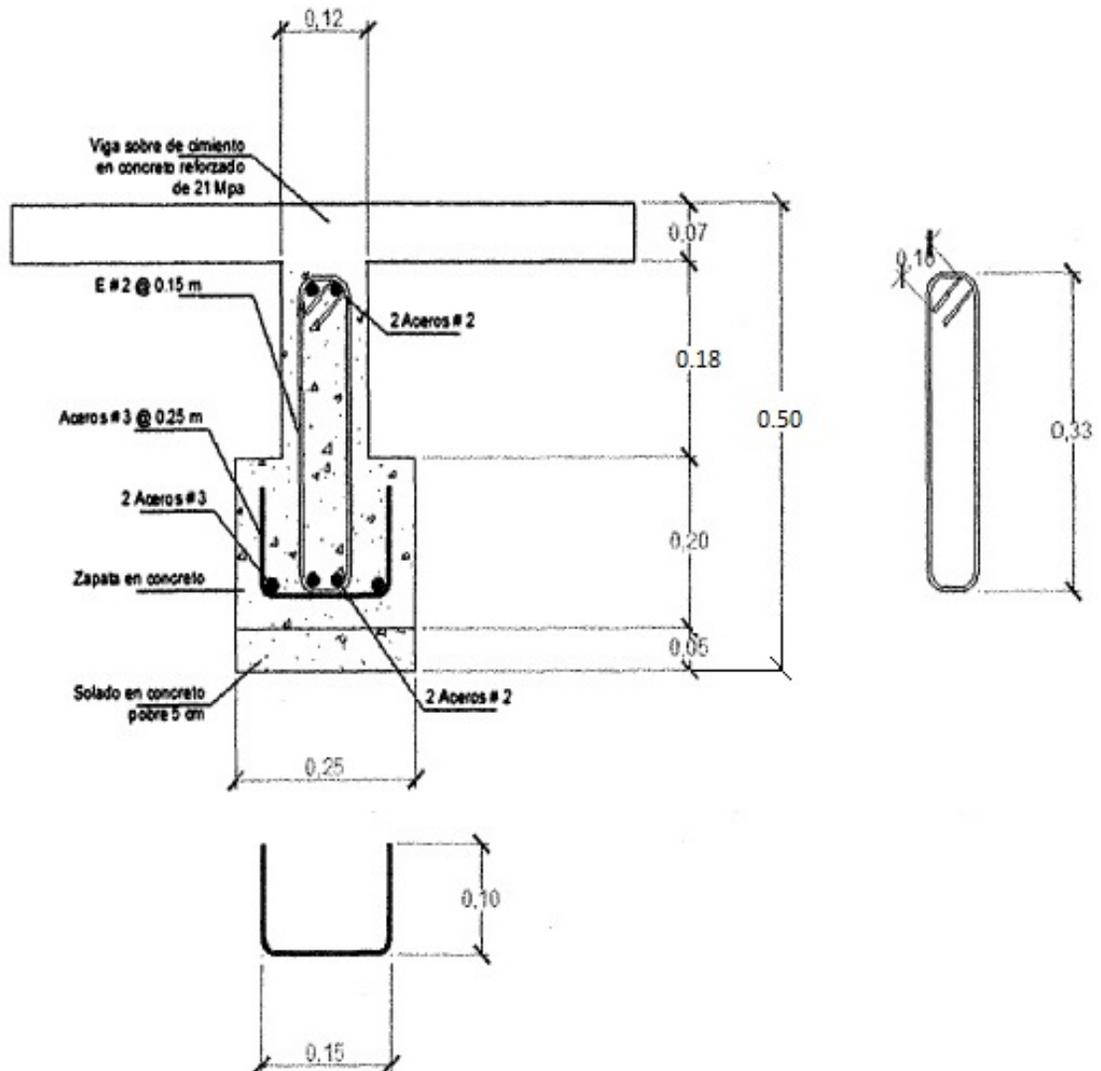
Plano estructural viga de cimentación MVSB Municipio de Totoró. Fuente: Comfacauca
